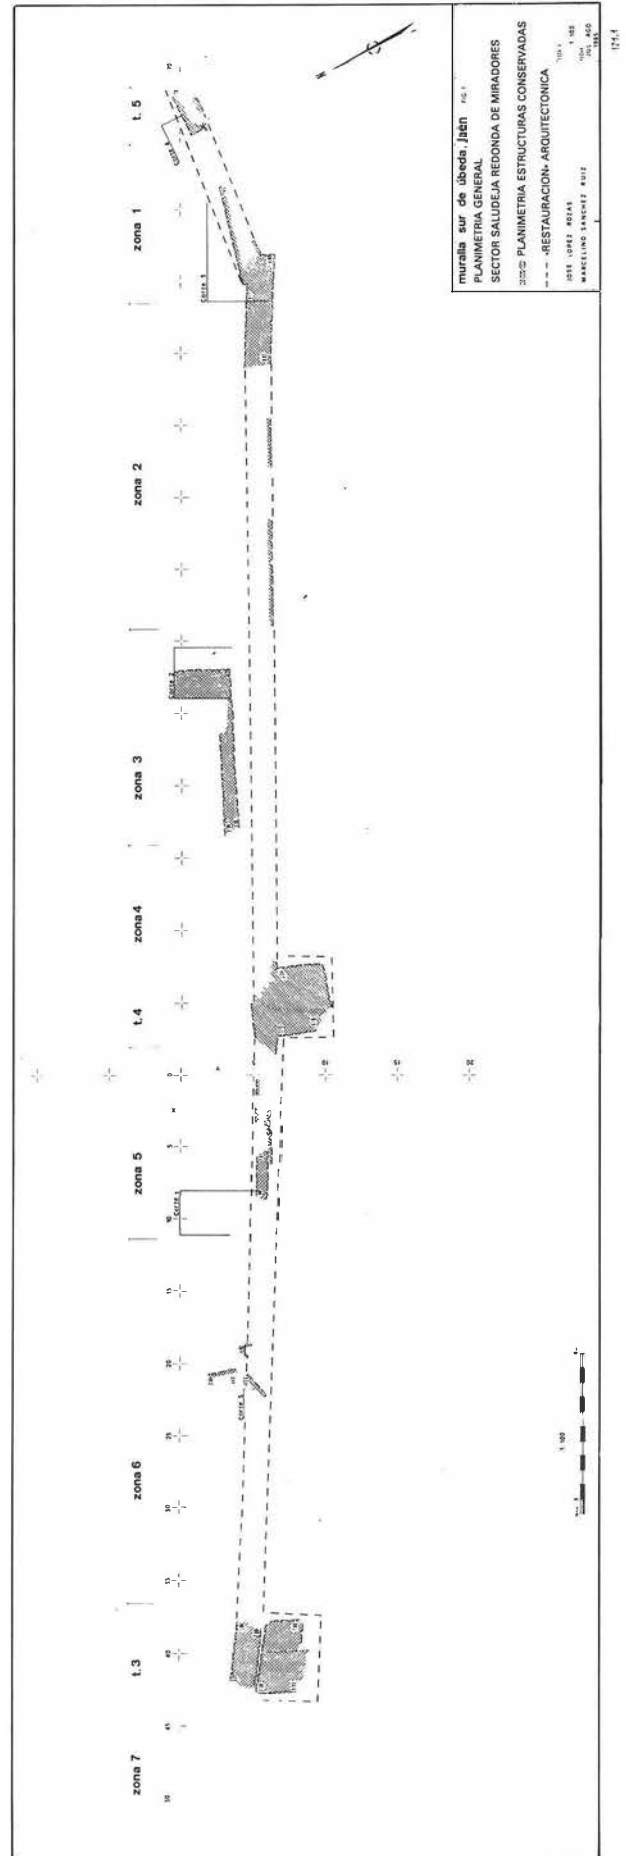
Muralla sur de Ubeda. Planimetría general, sector Saludeja. Redonda de Miradores.
